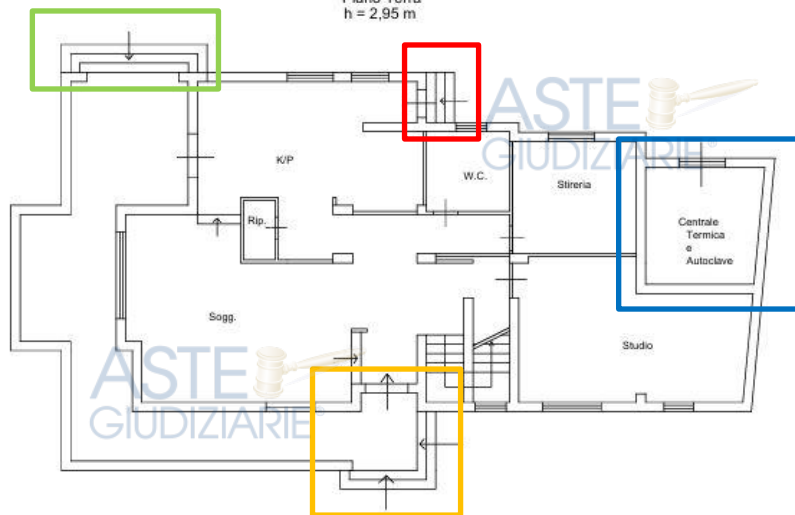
Planimetria Sub 7 Piano T Progetto Urbanistico
